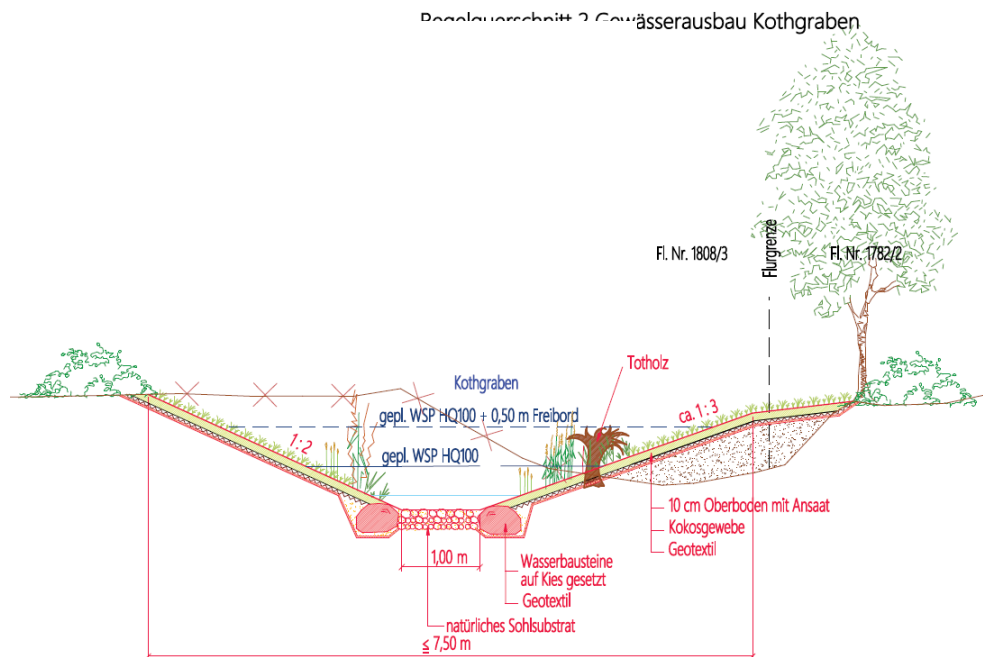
Planauszug – Planungsabschnitt Gewässerausbau Kothgraben, RQ 2
